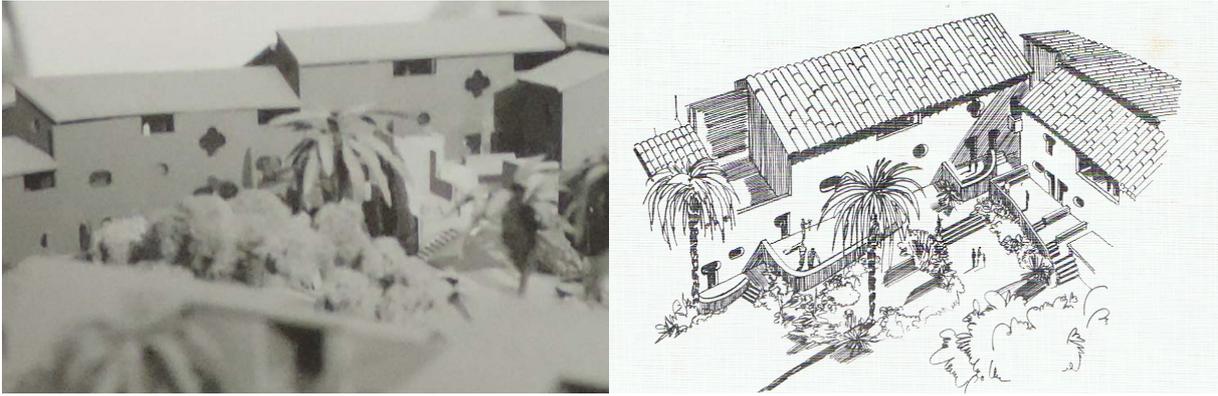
Outil de la maquette et du dessin pour un apport sensible dans la communication (source : Fond d'archive Jean Weiler)
